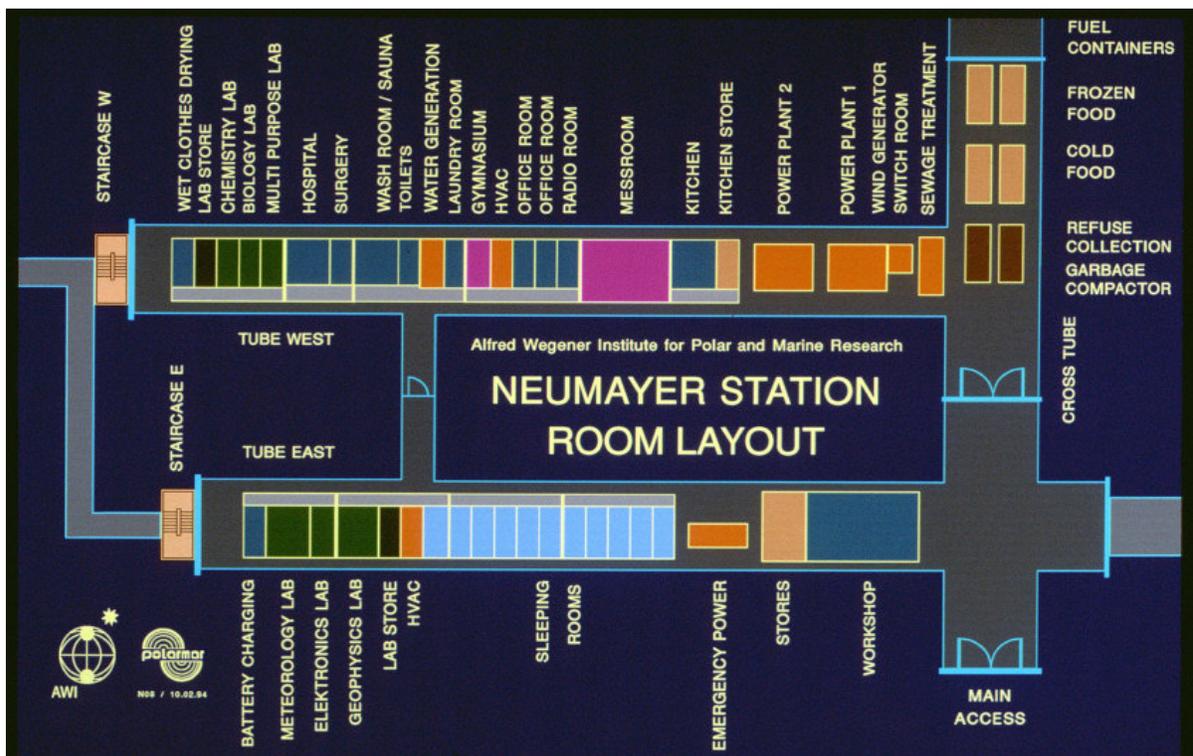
Neumayer-Station II - Lageplan der Einbauten
